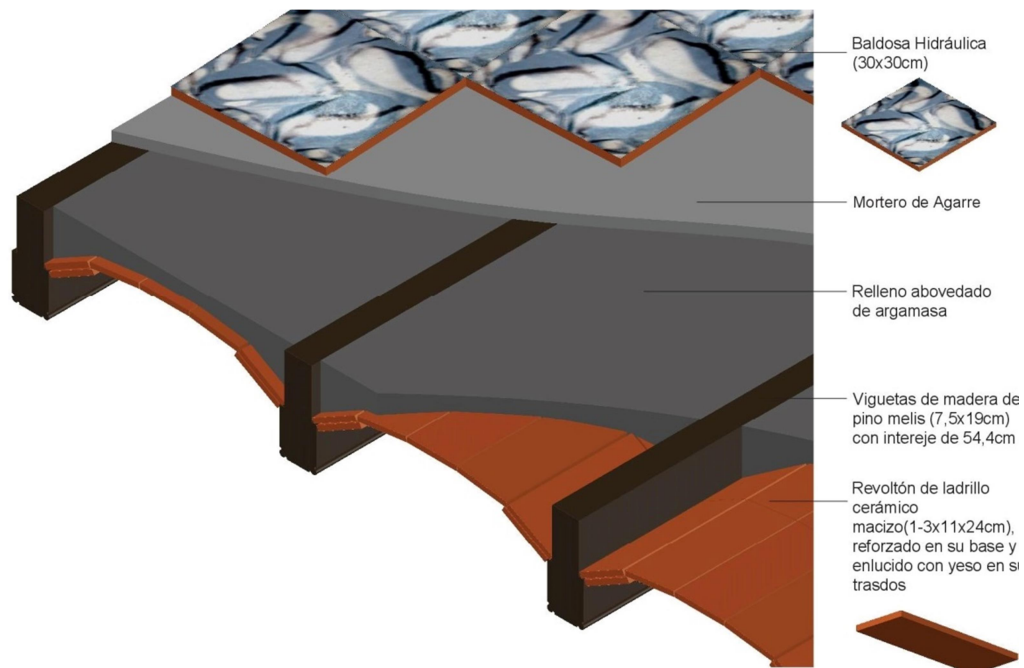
Detalle de forjado principal de revoltón de ladrillos con viguetas de madera maciza
